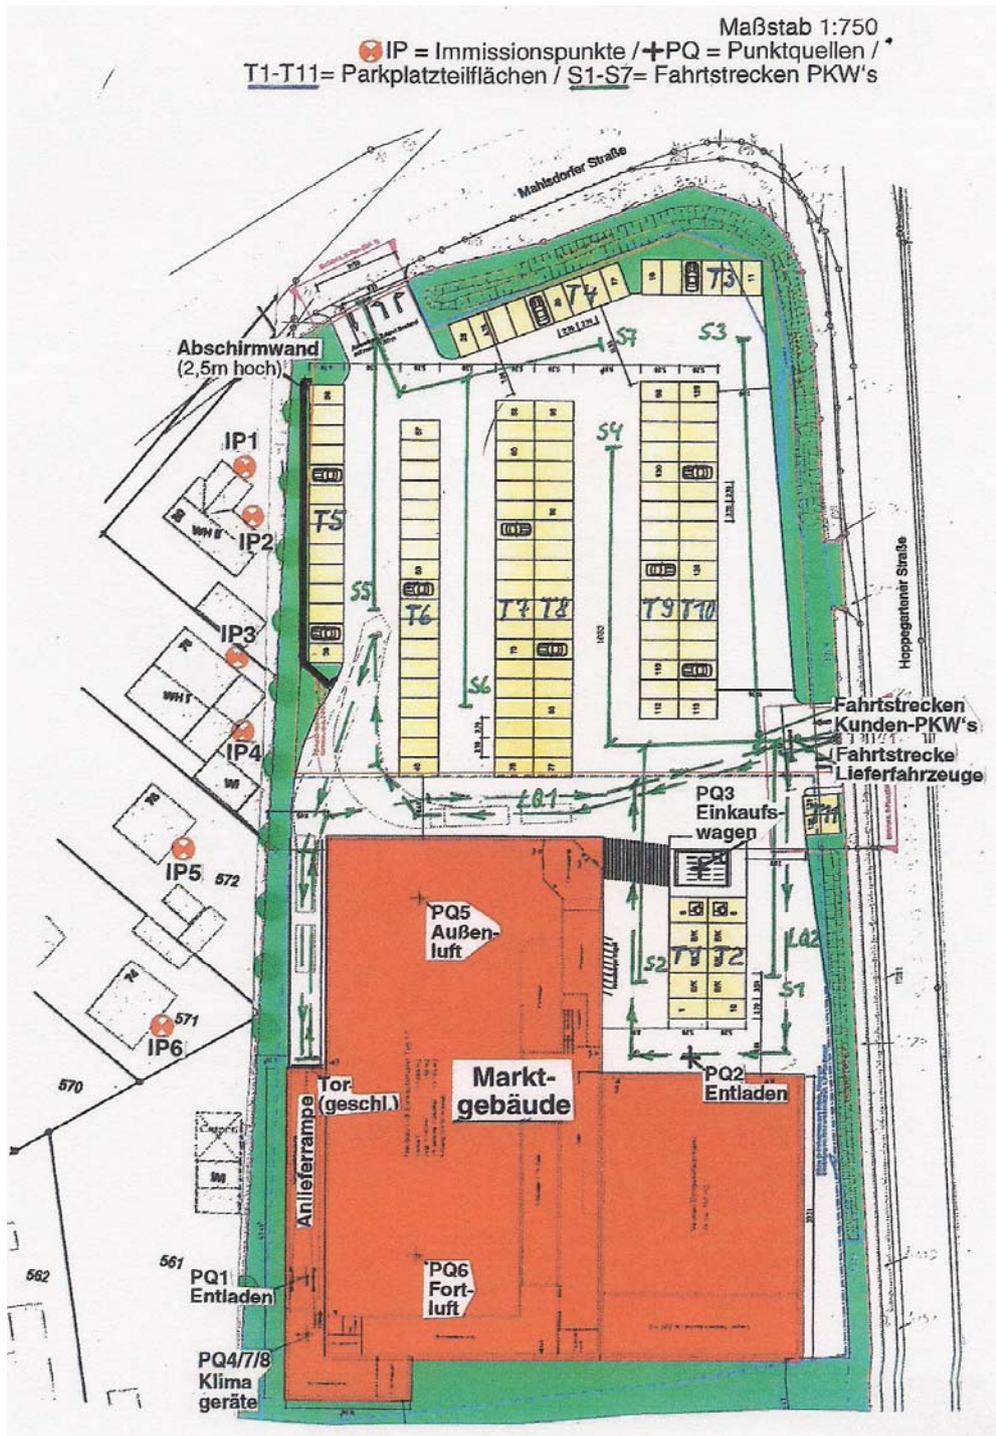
Lageplanskizze zur Schallimmissionsprognose mit eingetragener Schallschutzwand
